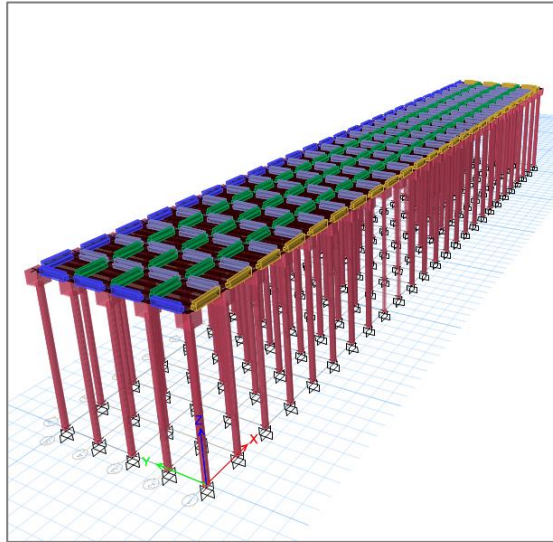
Modelado de la estructura con elementos tipo "Frame" con extrude; Fuente autor
